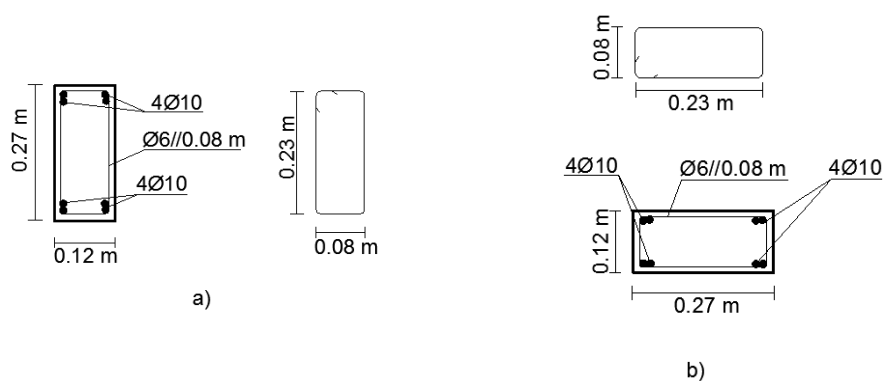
Corte transversal das peças P1 e P3, a) na viga e b) no pilar
